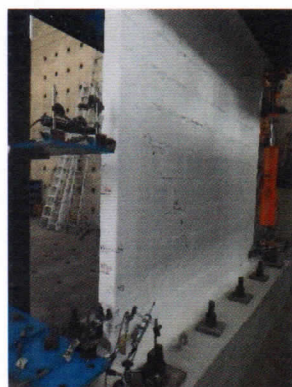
Aparición de primeras grietas en la parte central de la columna Este para una distorsión 1/1500.
